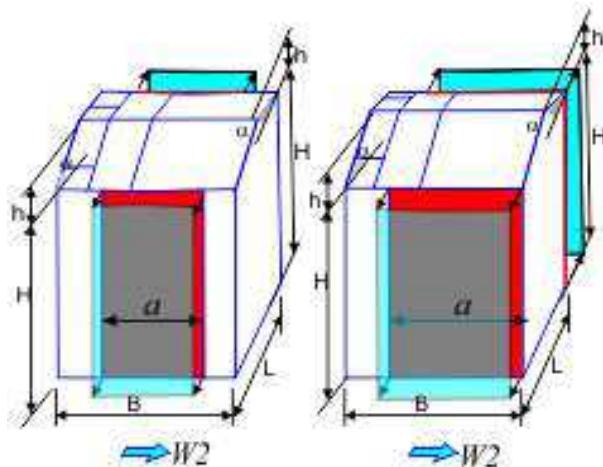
Схема приложения ветровой нагрузки на боковые стены
